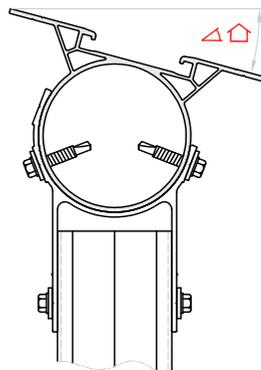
Einstellung der Dachneigung und Verschraubung.
